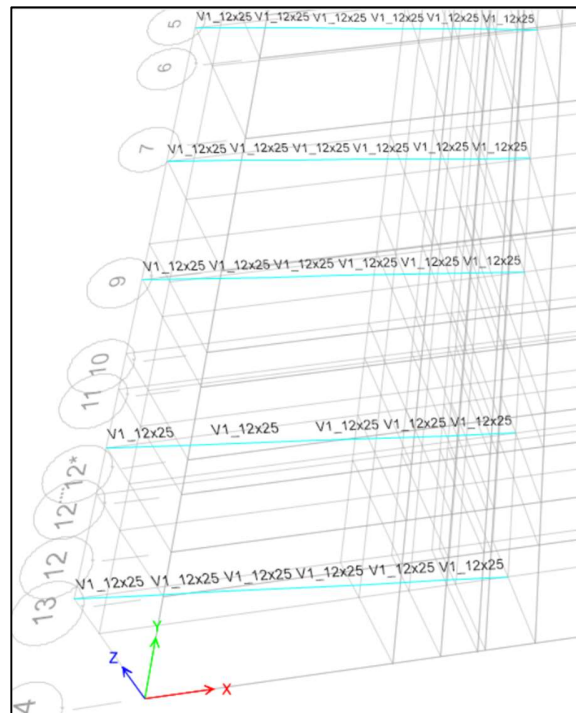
Secciones de vigas de cubierta (VI\_12CMX25CM). Sector entre ejes A-D y 5-14.
